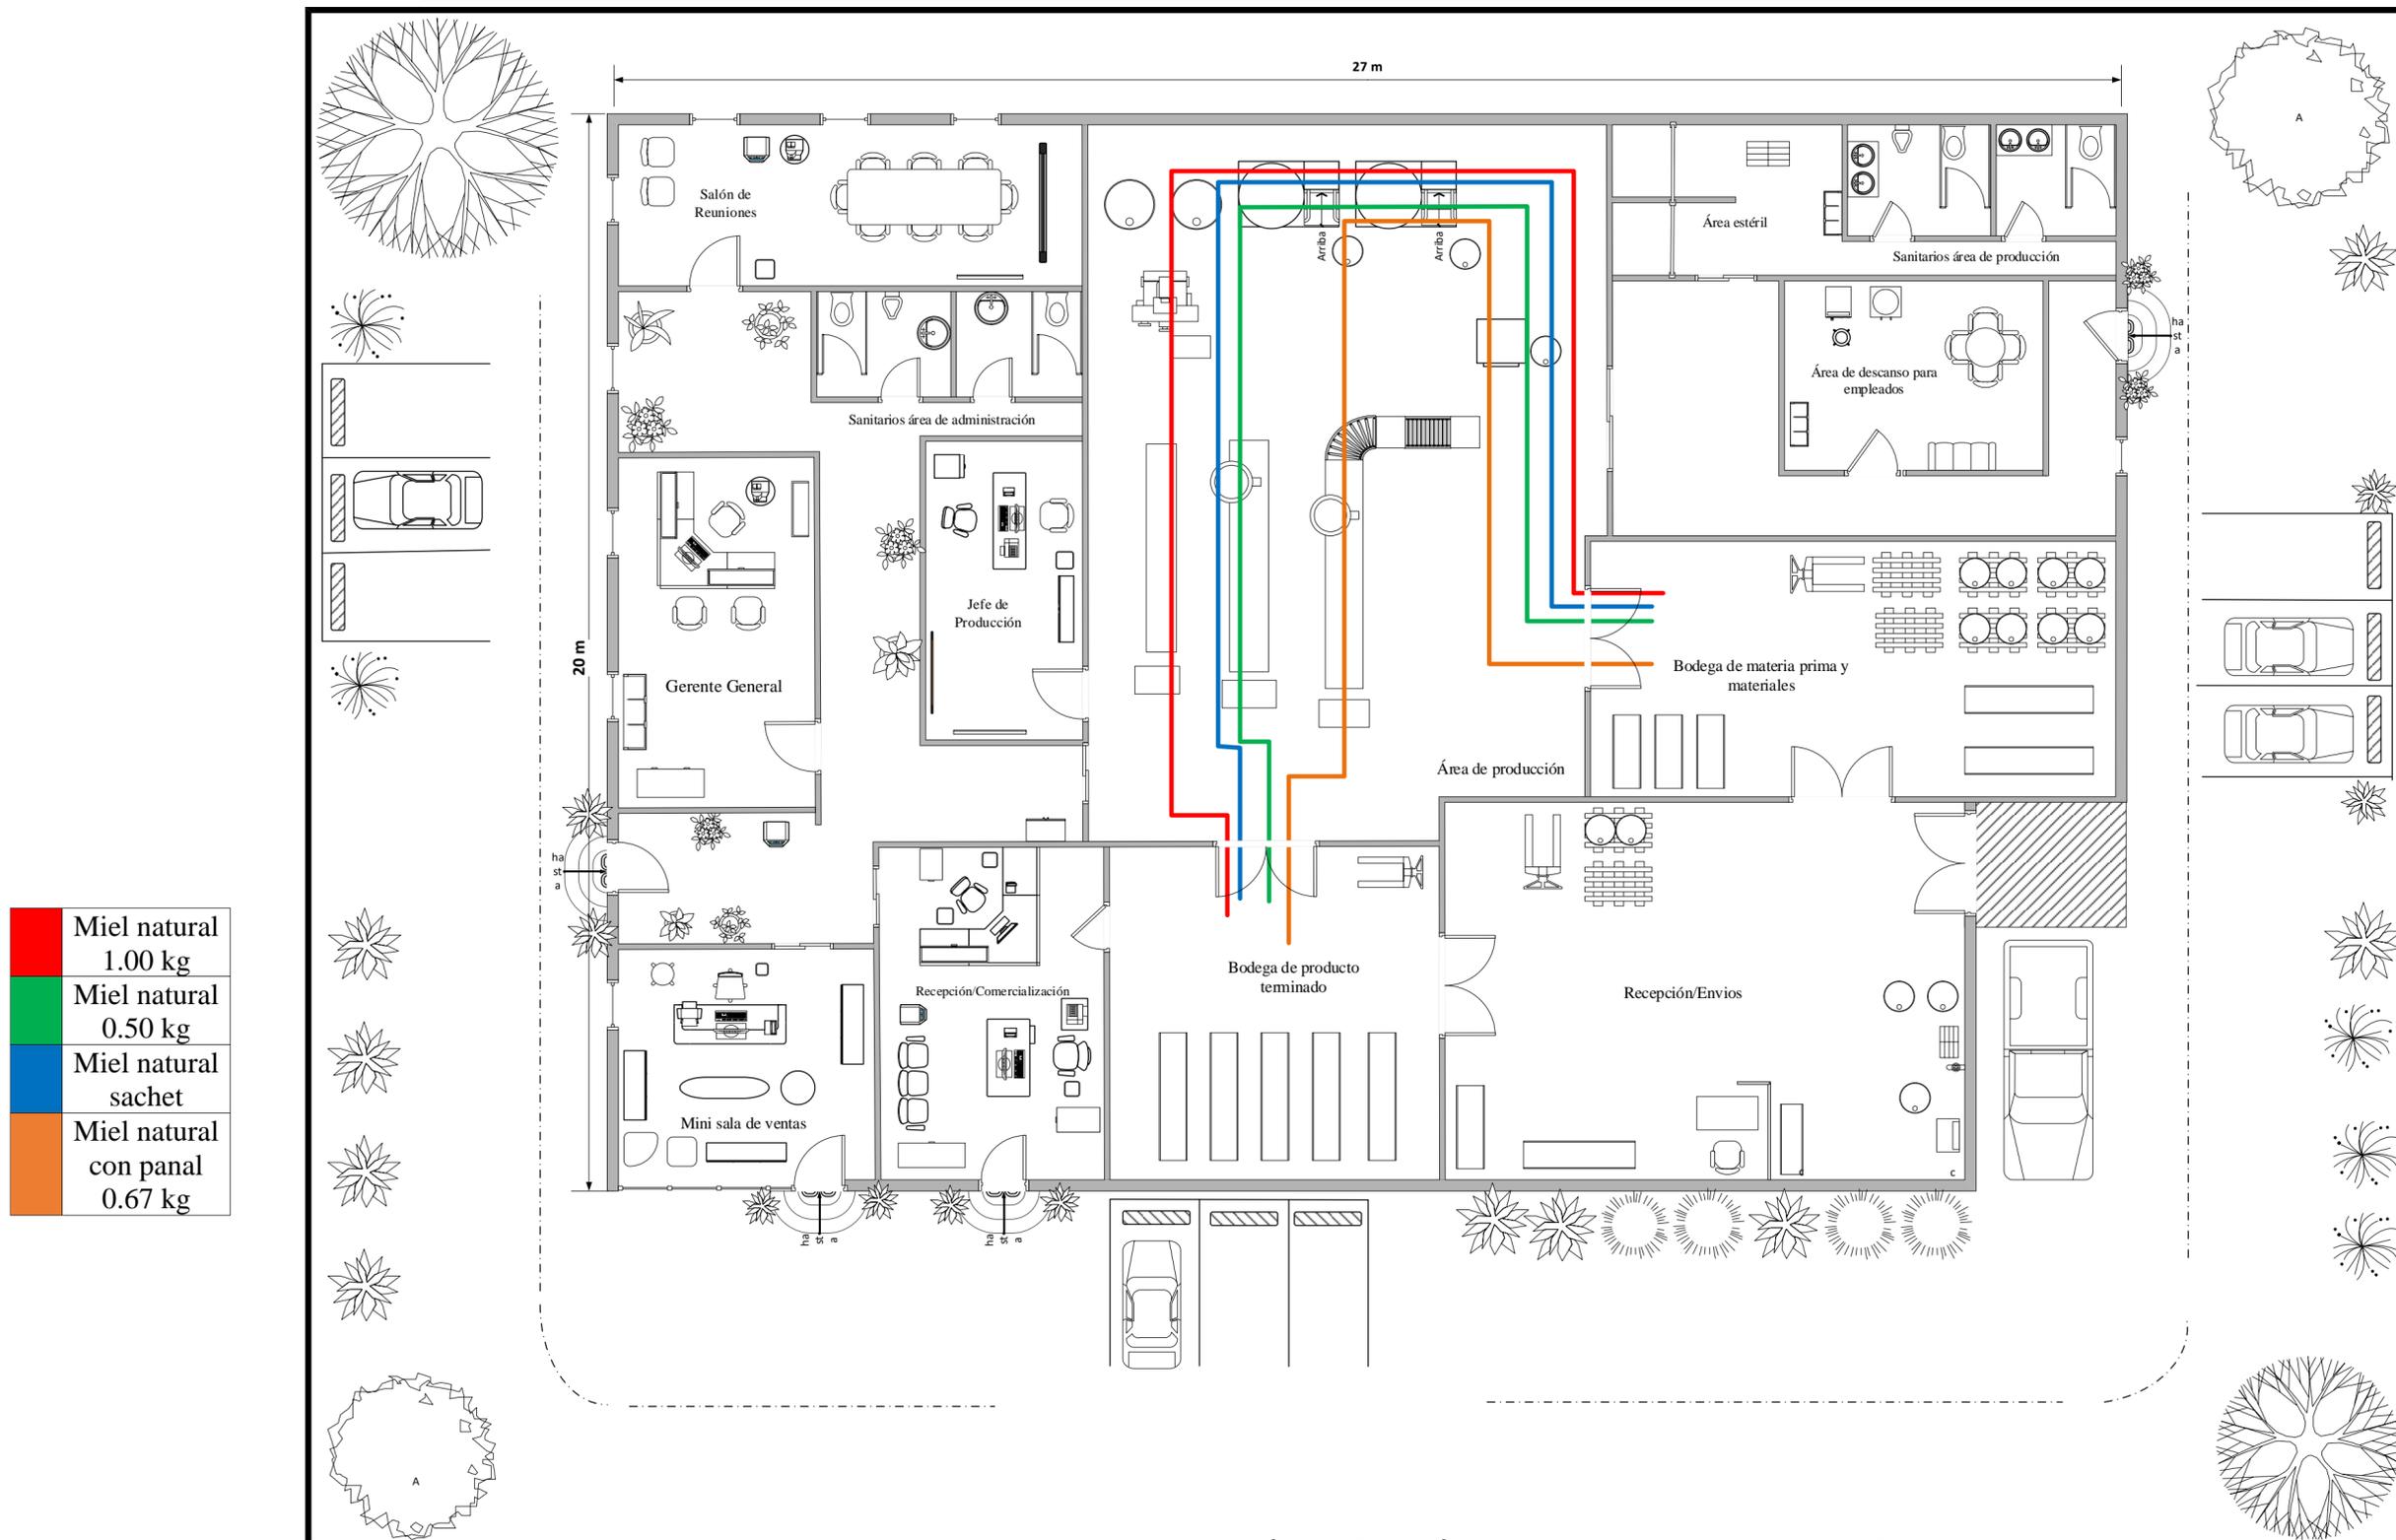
Distribución en planta propuesta para el modelo de empresa
